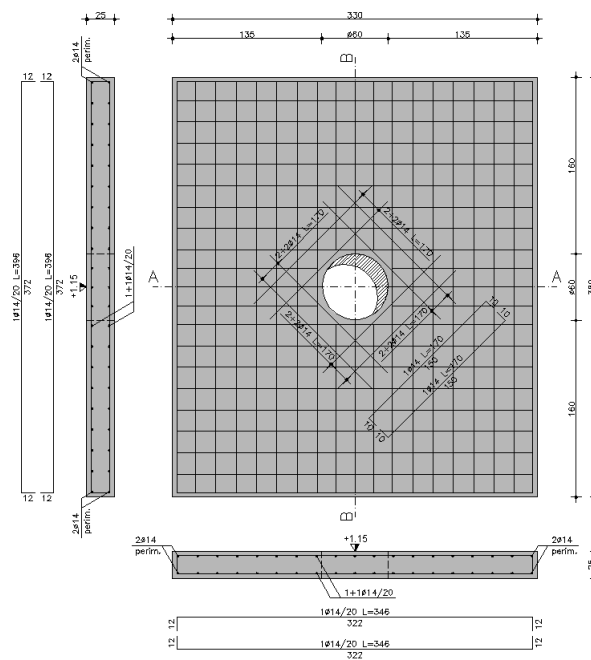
Pozzetto E - Pianta coperto appoggiato
